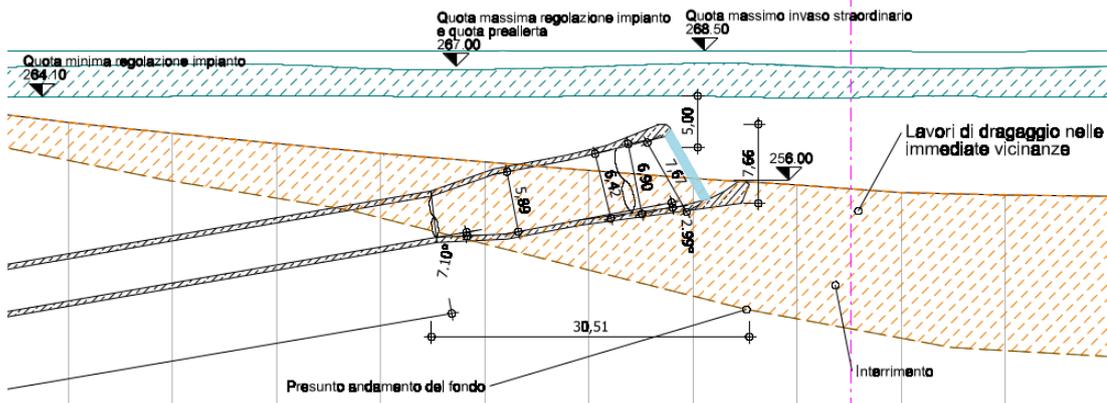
Sezione trasversale delle bocche di presa e restituzione (estratto Tavola PD-EP.21.2).
